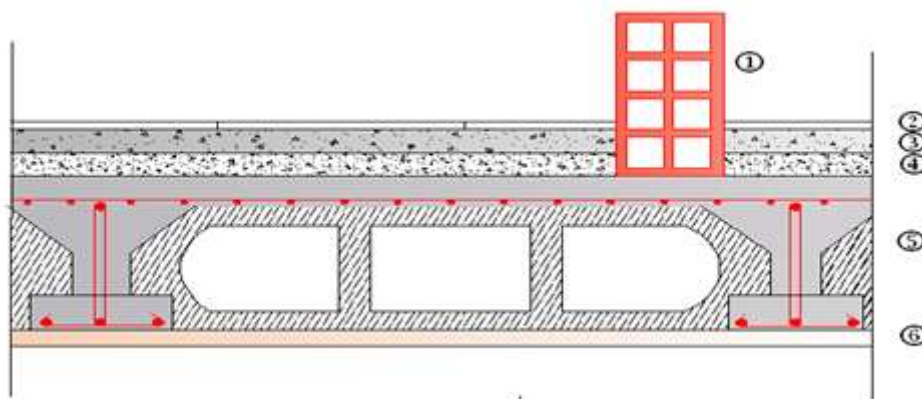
Coupe d'un plancher d'étage courant en corps creux.
